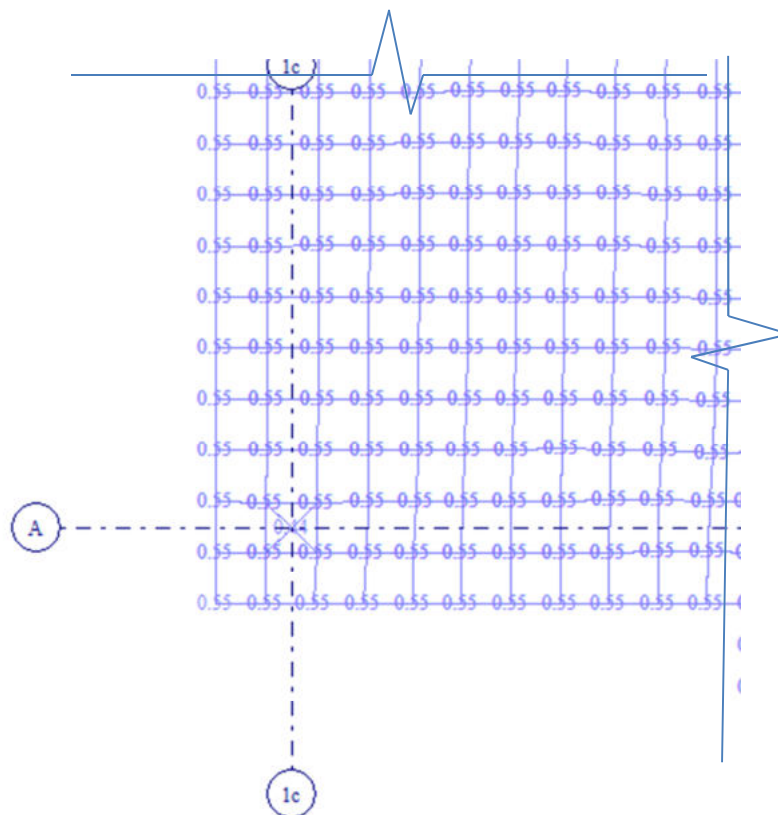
Фрагмент плиты с указанием нагрузок от собственного веса перекрытия
